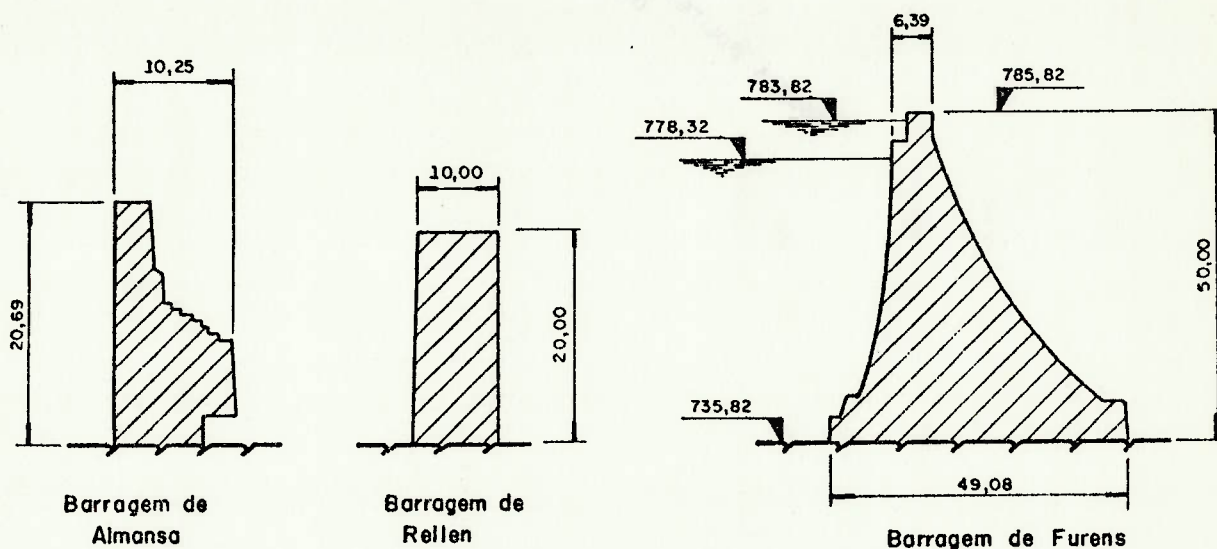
Exemplos de perfis das primeiras barragens (Andrade, 1982)
